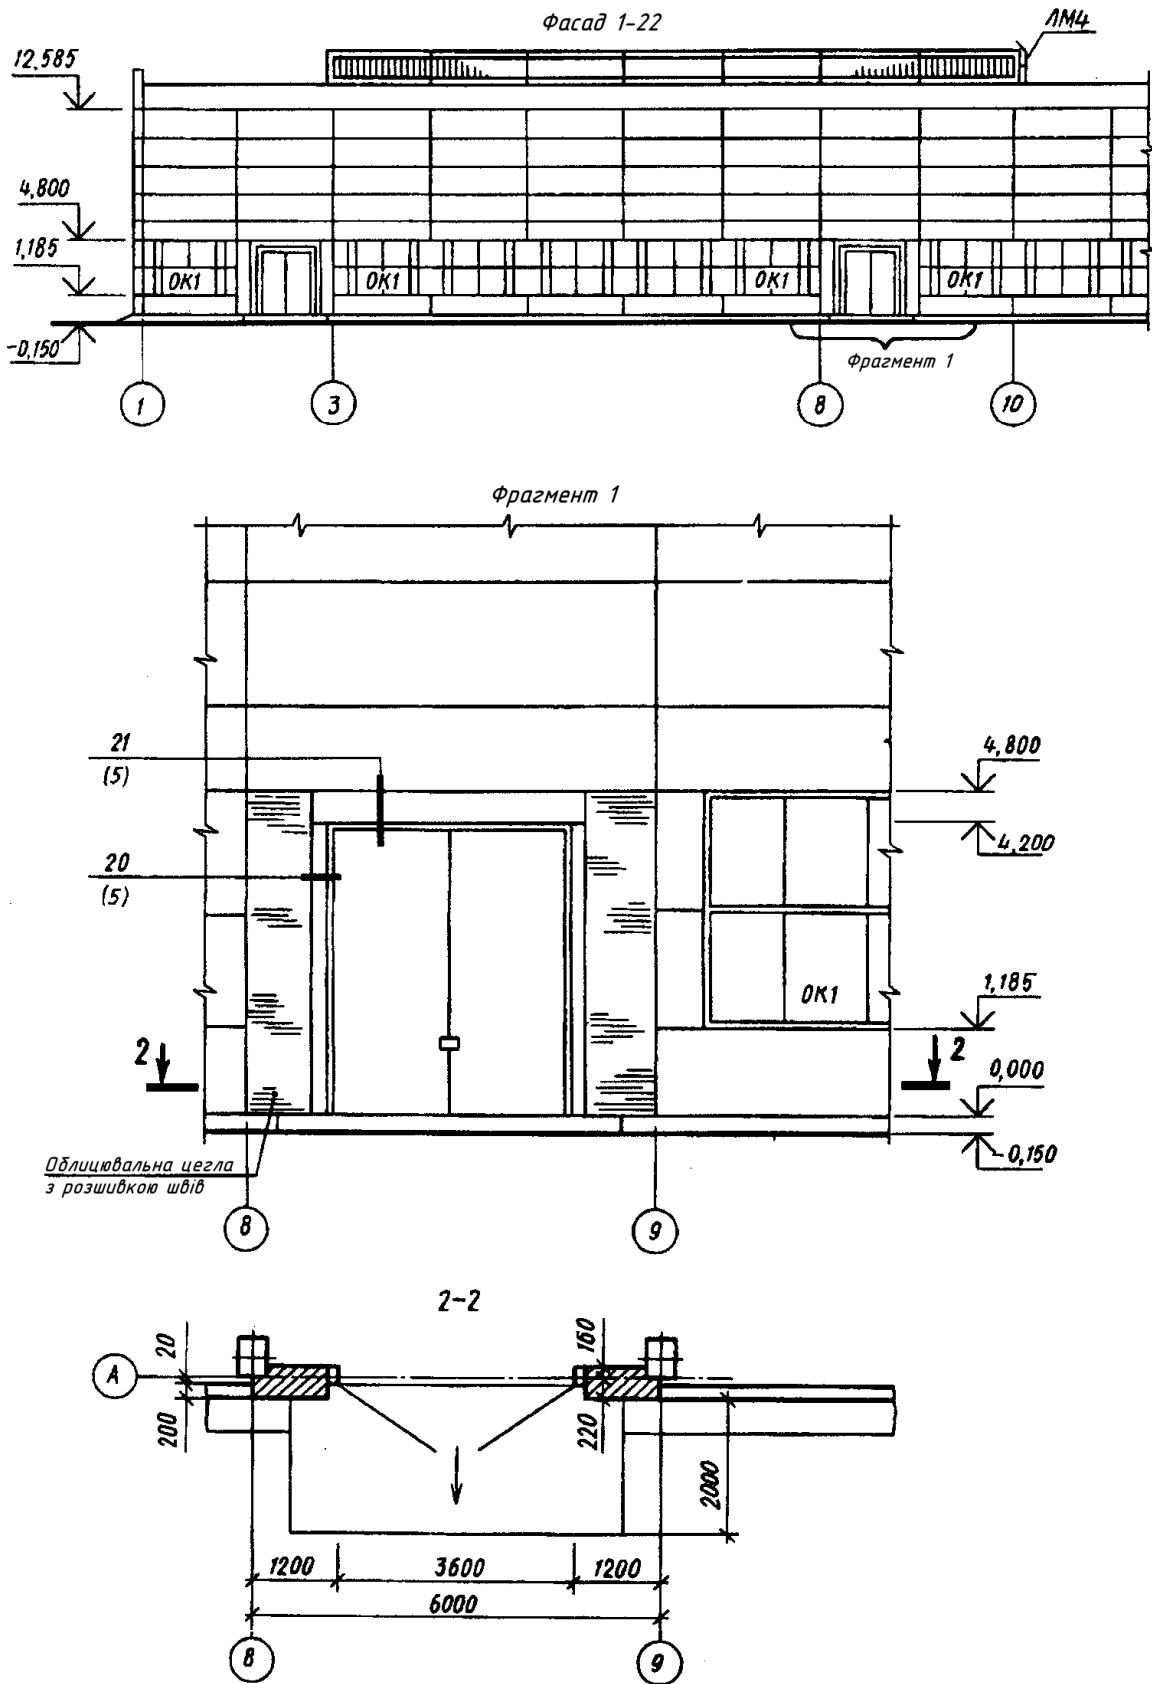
Приклад виконання фрагмента фасаду
